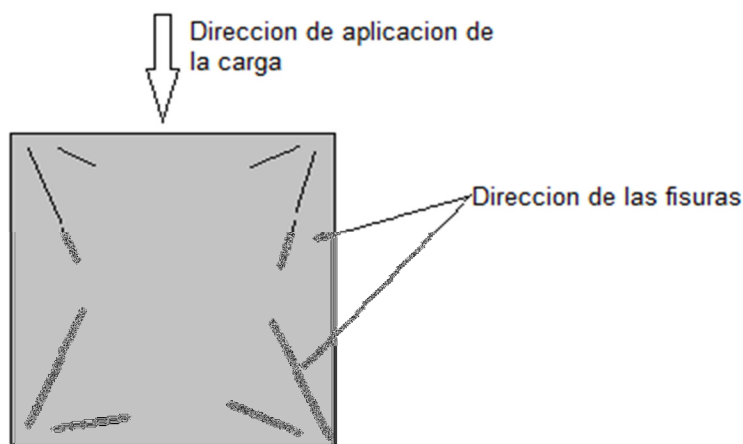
Patrón de fisuras de las probetas de hormigón
